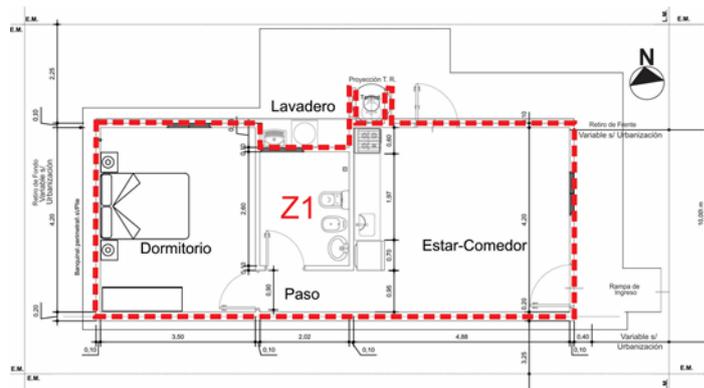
Planta de la Vivienda Universal –VU– DPVyU. El caso de estudio 1 se encuentra aislado. La línea roja indica la Zona Térmica 1 (Z1) estudiada en el aplicativo. Plan de 19 unidades para el departamento Garay, Prov. de Santa Fe, en la localidad de Cayastá, se ejecutaron 5 unidades. Año: 2018. Fuente: www.santafe.gob.ar
